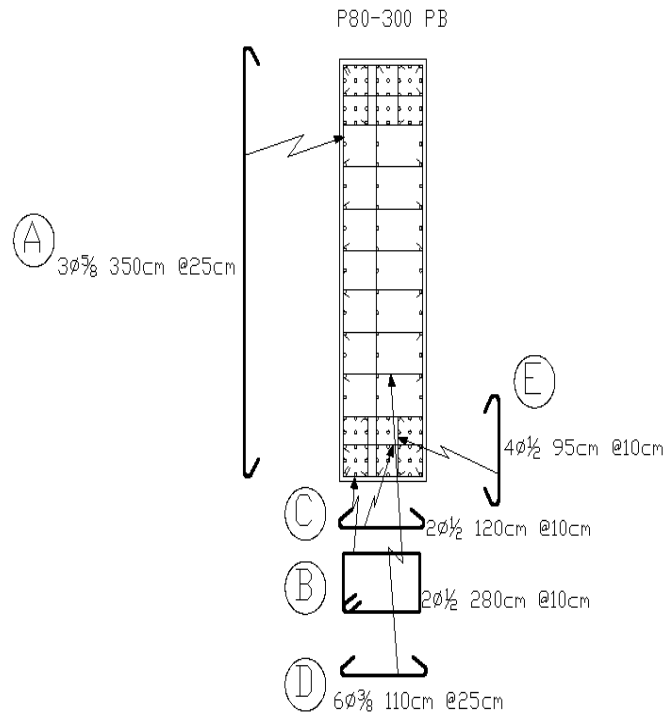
Sección transversal de muro dirección Y nivel PB.
